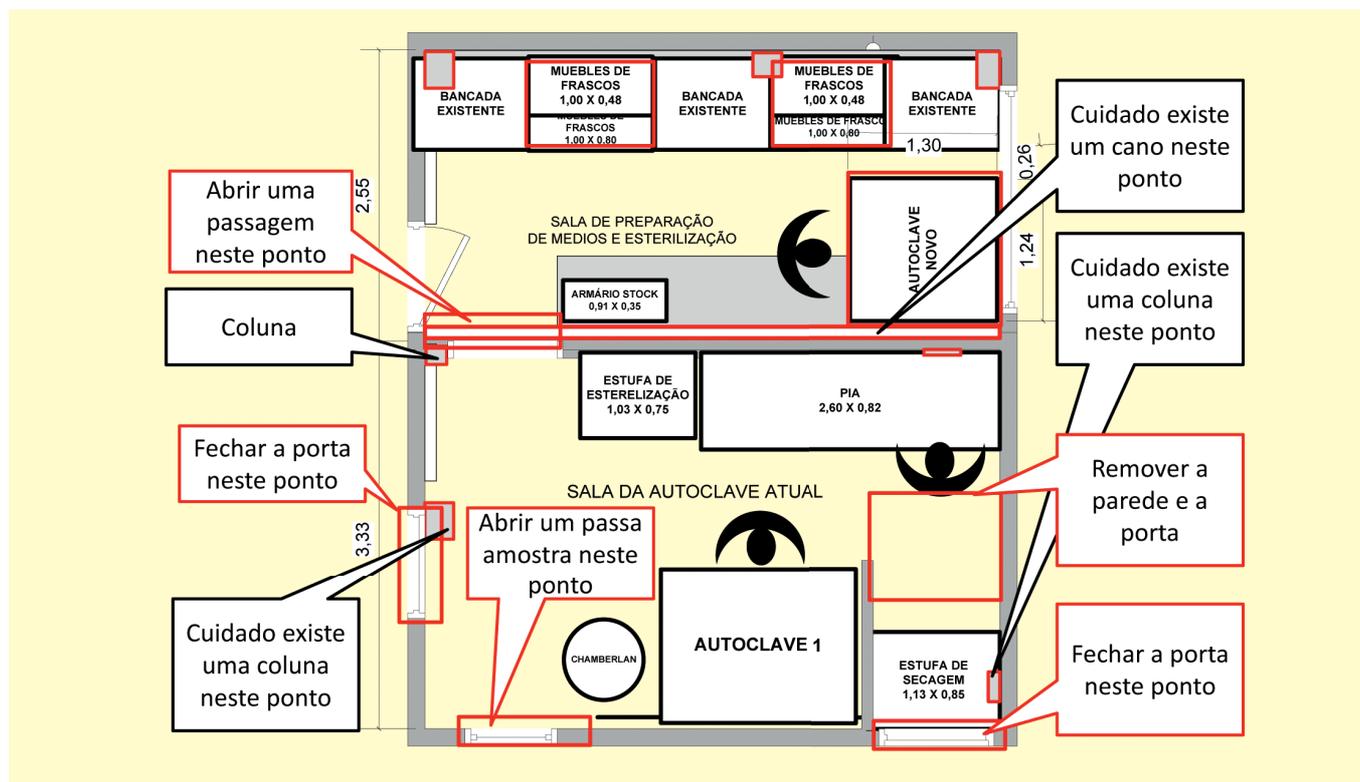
Layout e recomendações para as novas Salas de Esterilização
